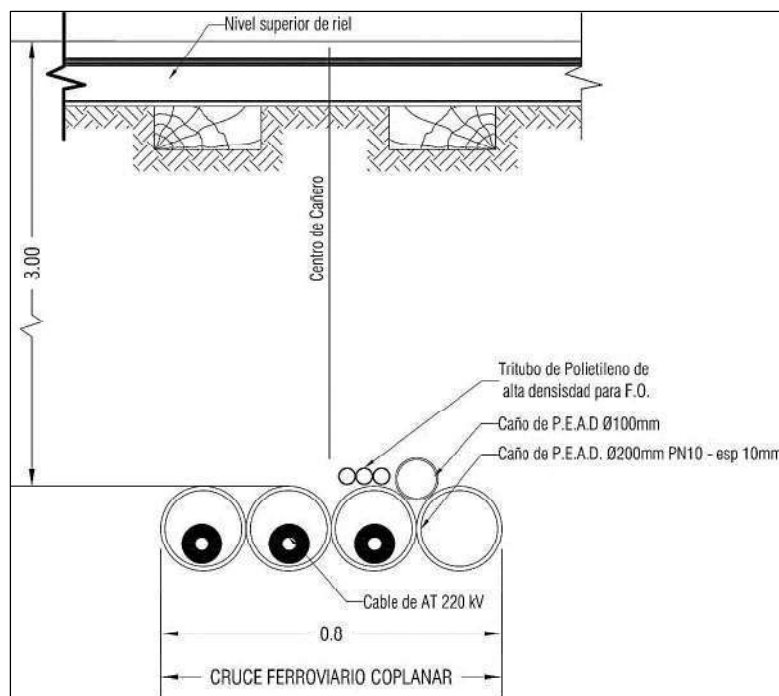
Cruce del FFCC Mitre. Vista en Corte Transversal
